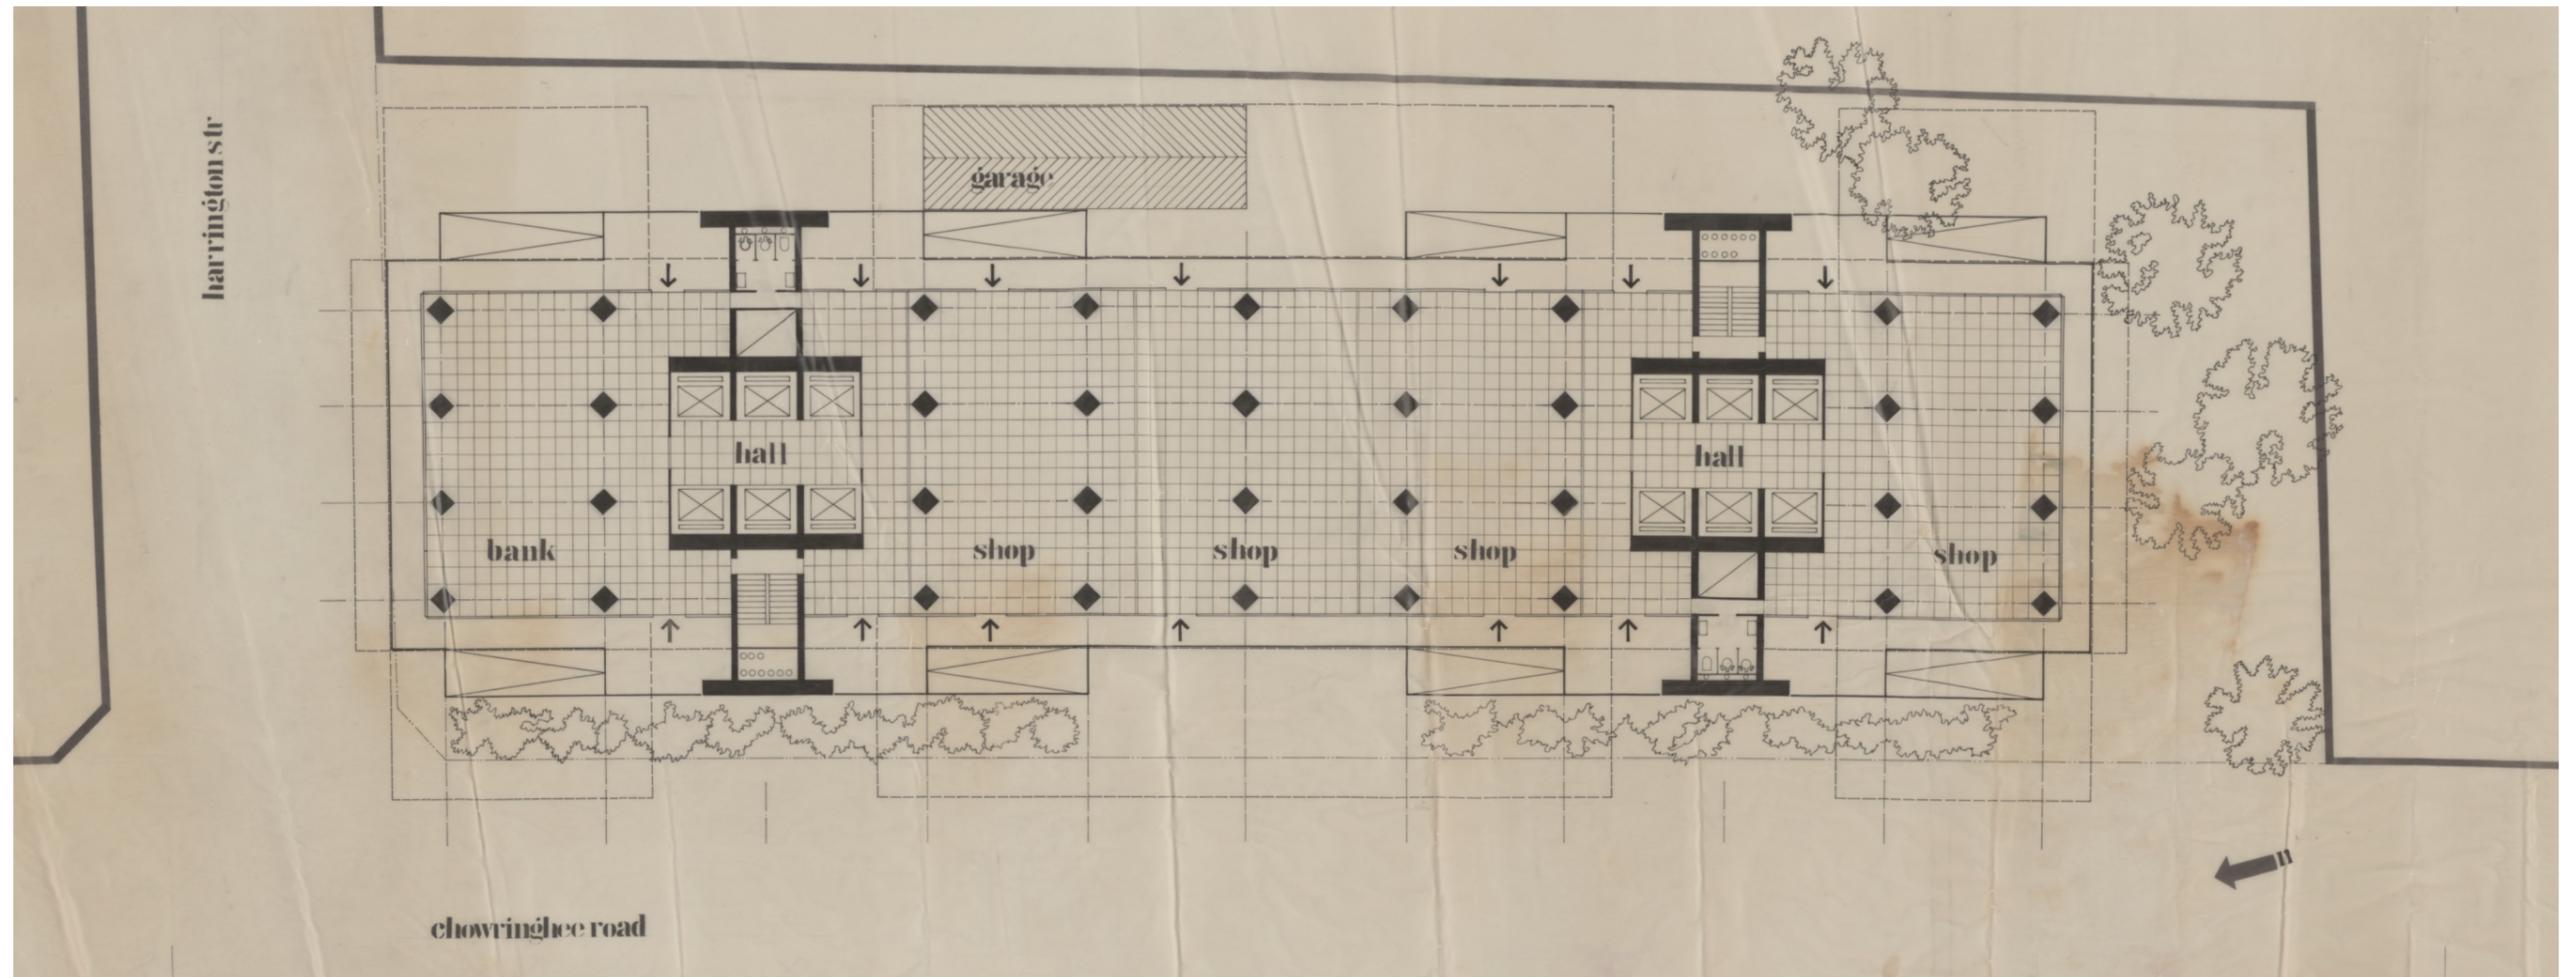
Erdgeschoss mit Umgebung (Grundriss), 1:100, 4.6.1961
